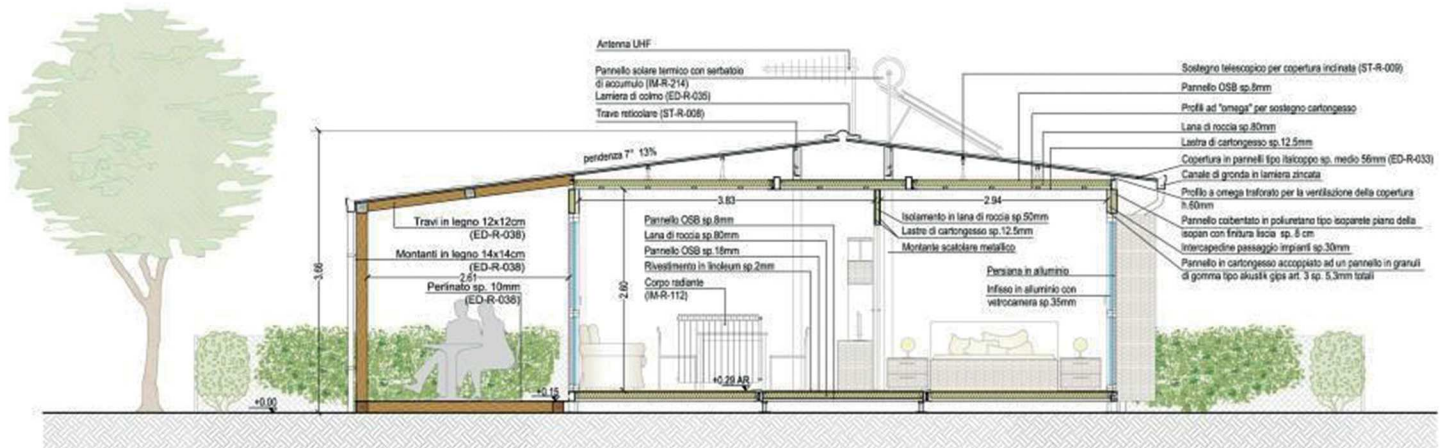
Sezione Longitudinale S.A.E. 40mq -
